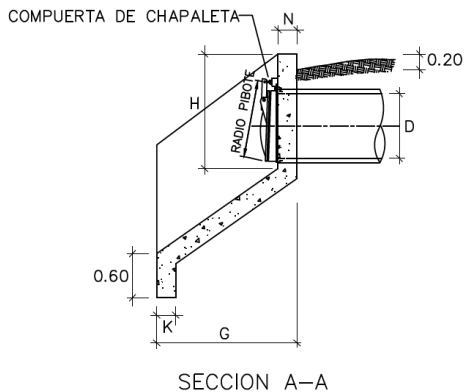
Detalle de las obras del cabezal de descarga, vista en corte longitudinal.
